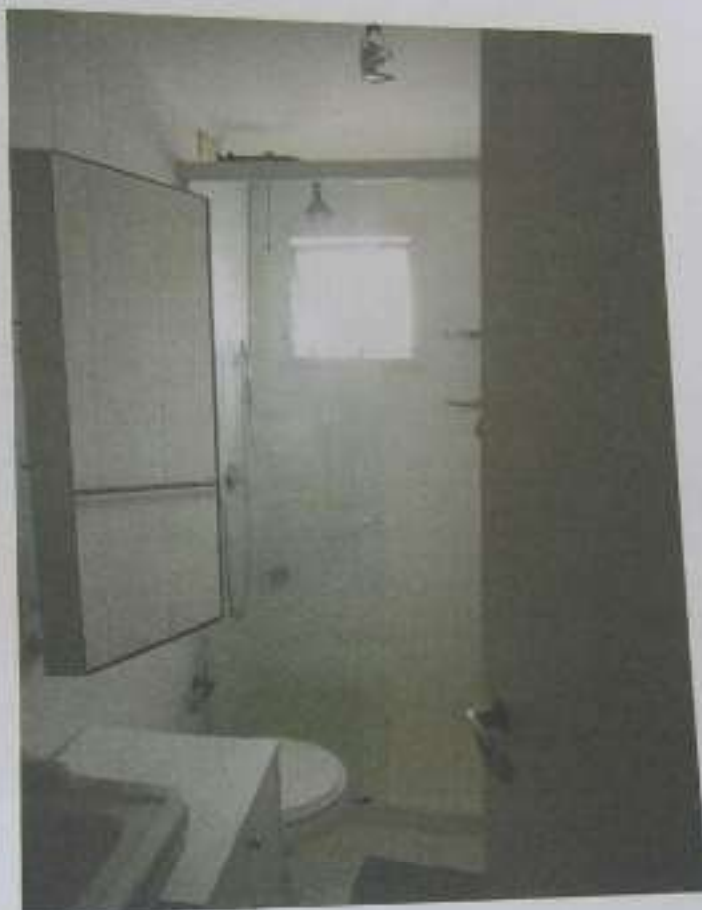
Vista do banheiro do terceiro dormitório.
